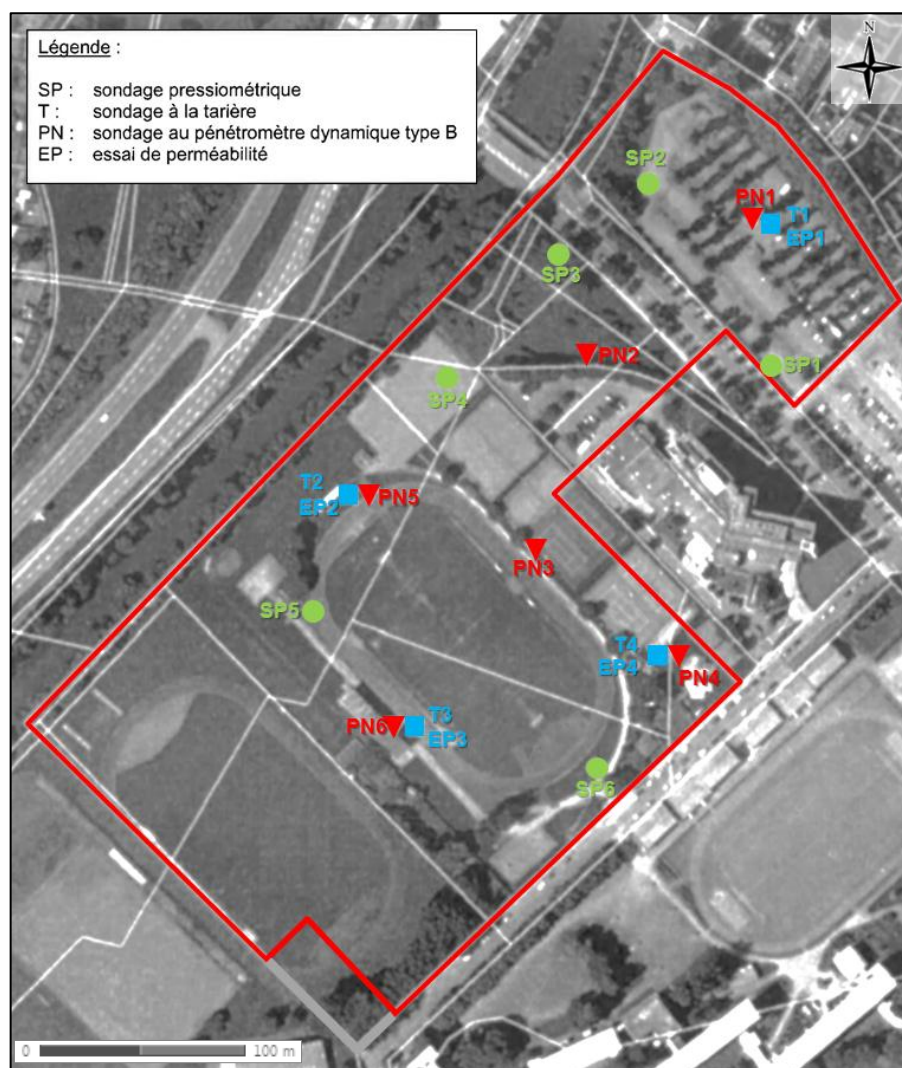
Plan d'implantation des sondages GINGER CEBTP – site PEX (février 2013)
